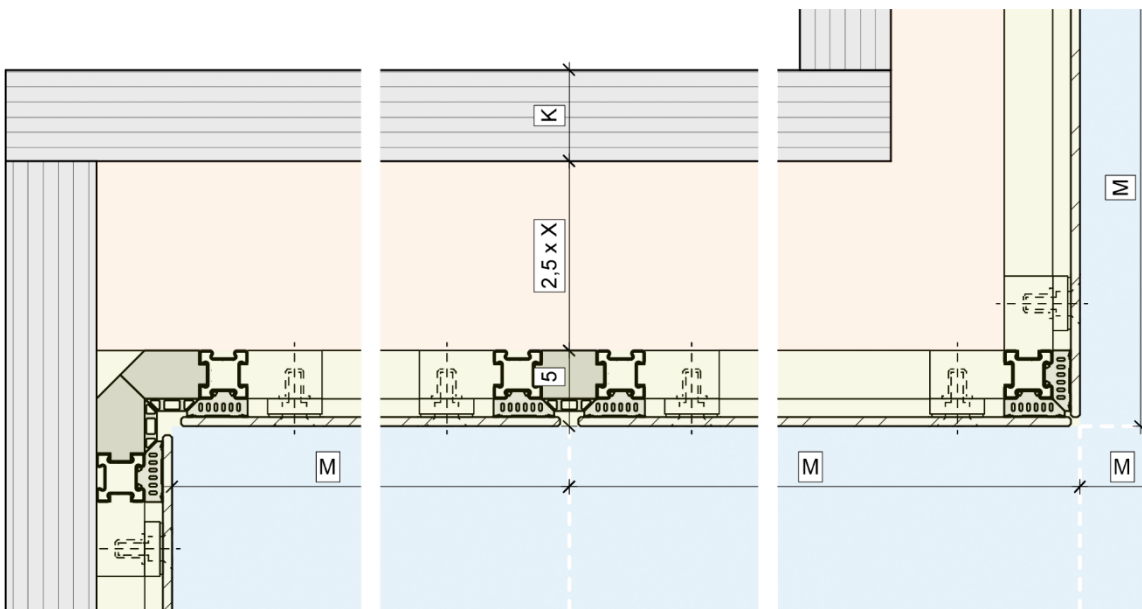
Detailausbildung mit Darstellung der Schichten - Innenecke, Modulstoß, Außenecke M 1:5
